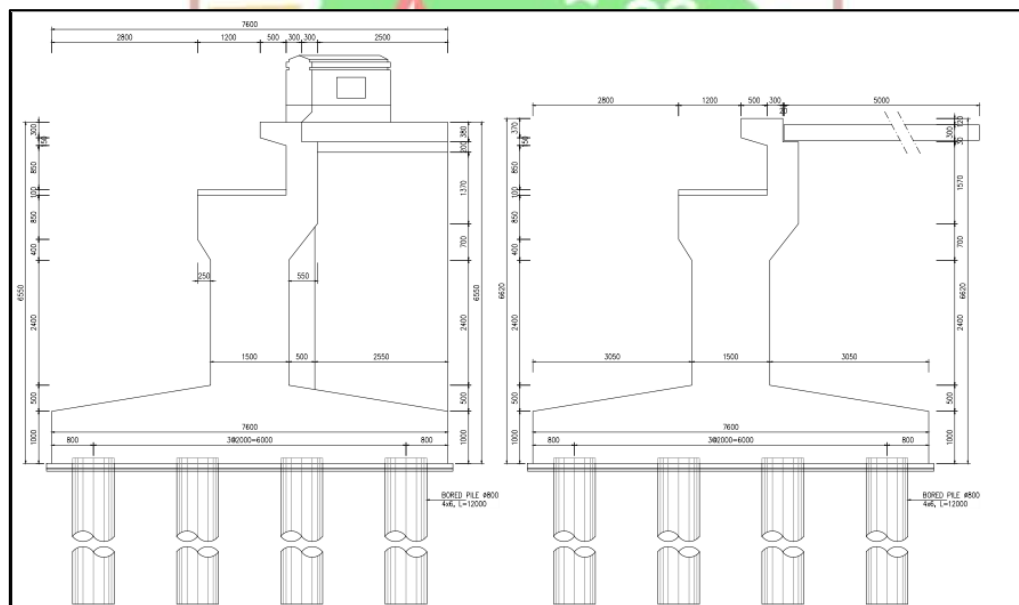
Potongan Melintang Jembatan Abutment 1
